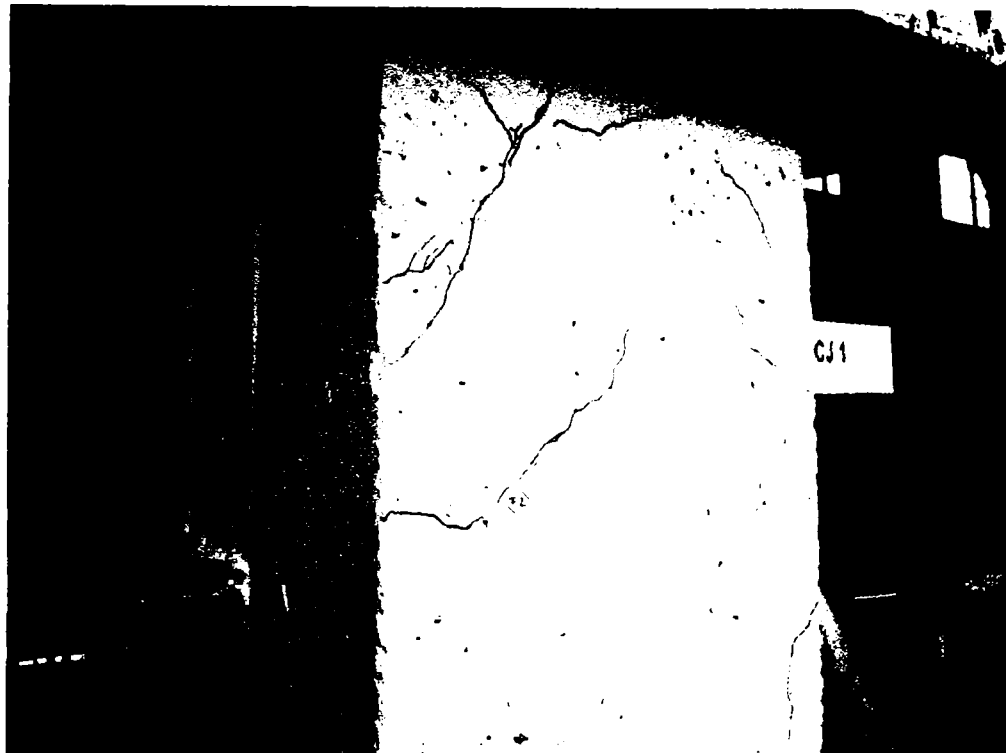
Starea de fisurare –vedere din spate
